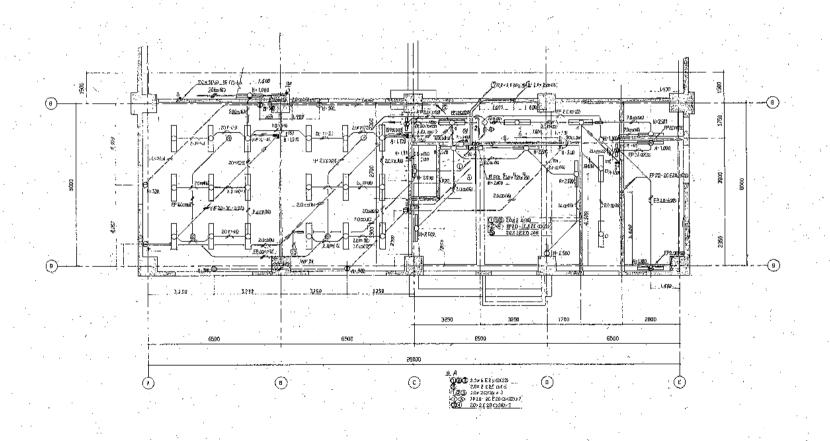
汚泥濃縮棟 2 階平面図 1 図番 7
